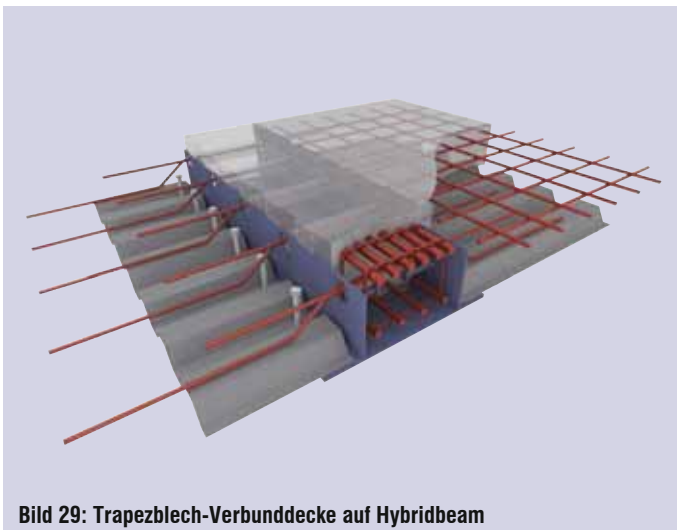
Trapezblech-Verbunddecke auf Hybridbeam
